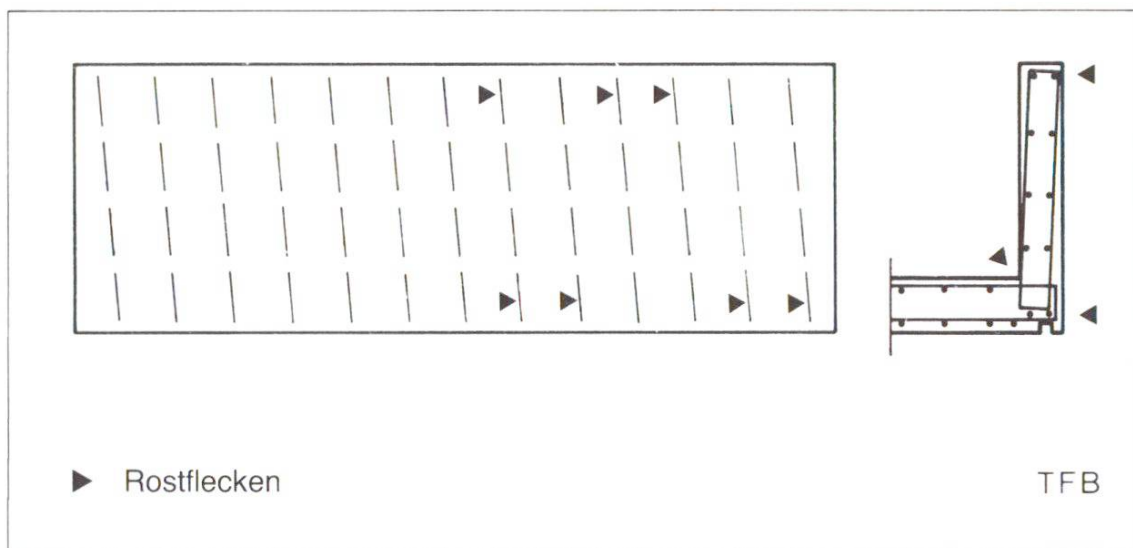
Balkonbrüstung aus Ortbeton. Infolge Rostflecken (oben und unten) wurde die Armierung gesucht. Mit dem Messgerät konnte festgestellt werden, dass die Bügel doppelt schief eingelegt worden waren.
